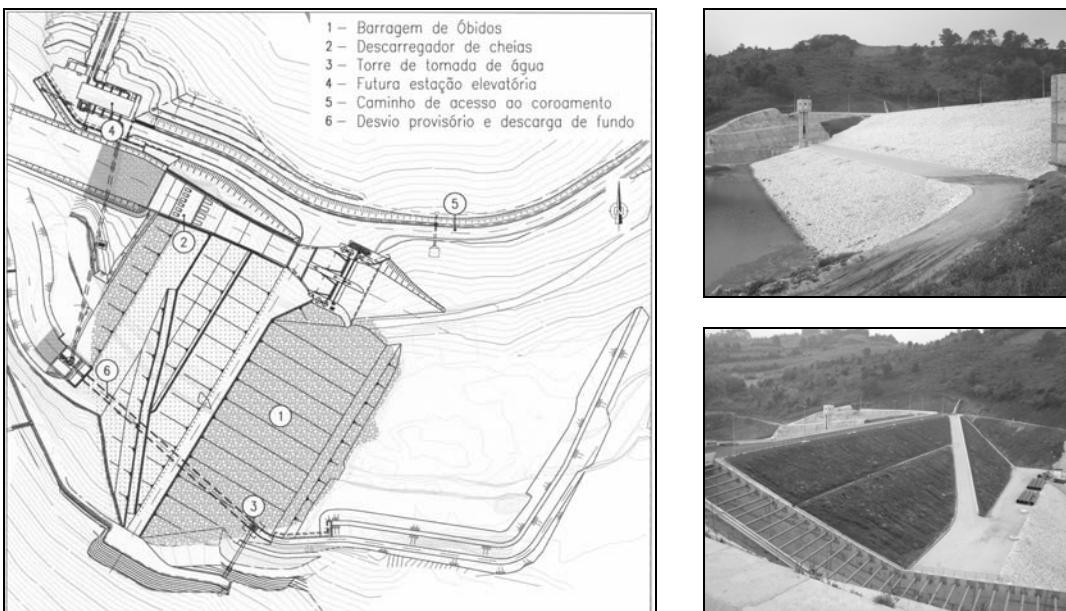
Planta geral e vistas de montante e de jusante da barragem
